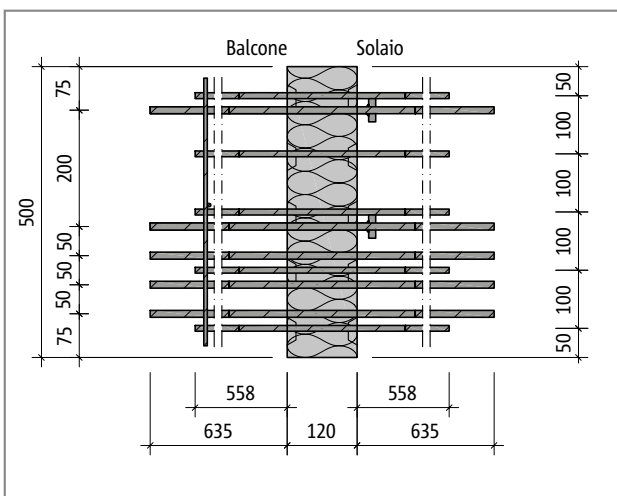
Schöck Isokorb® tipo EXT30-R-V10: pianta del prodotto
